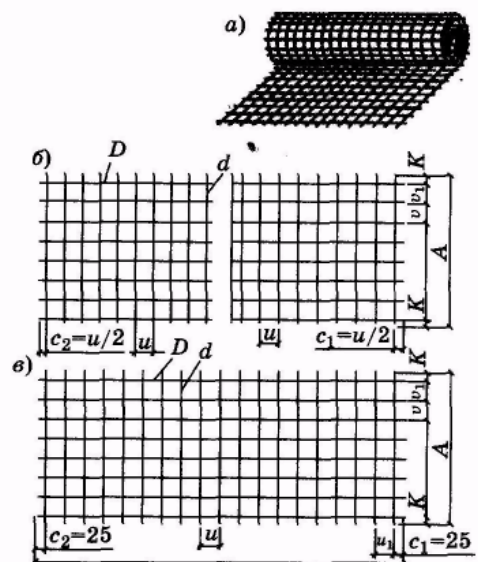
Сварные сетки: а – рулонная; б – после развертки; в – плоская
